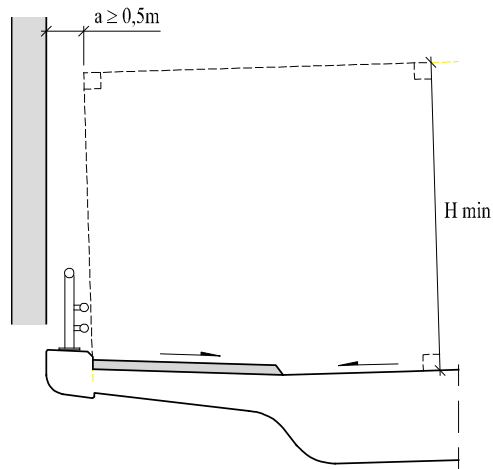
Fri høyde og bredde over kjørebane med ensidig tverrfall
